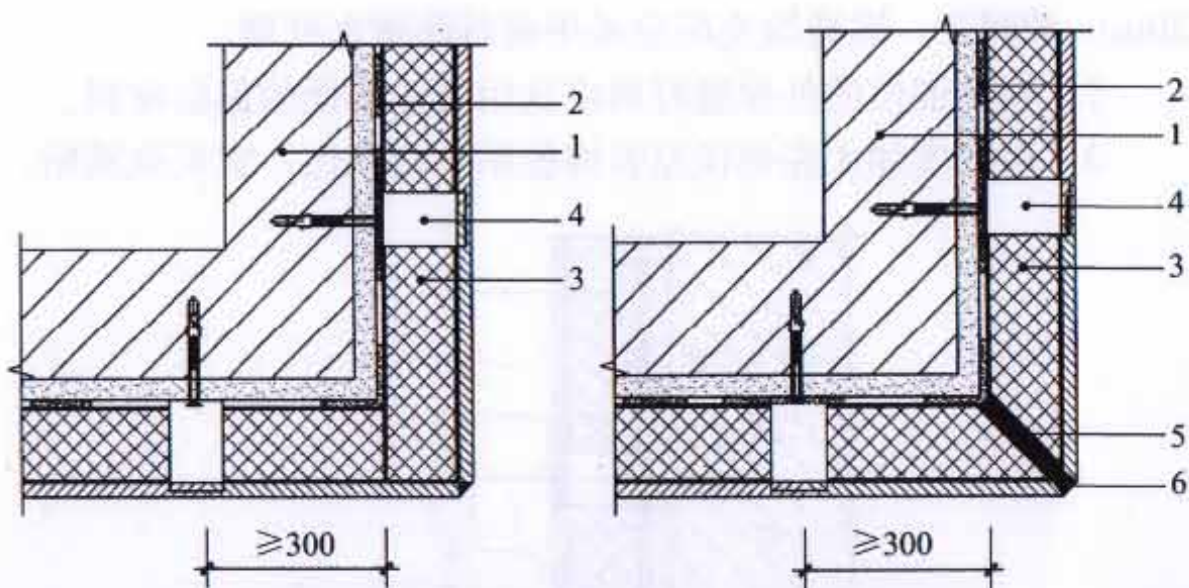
阳角构造示意（直角构造与对角构造）
